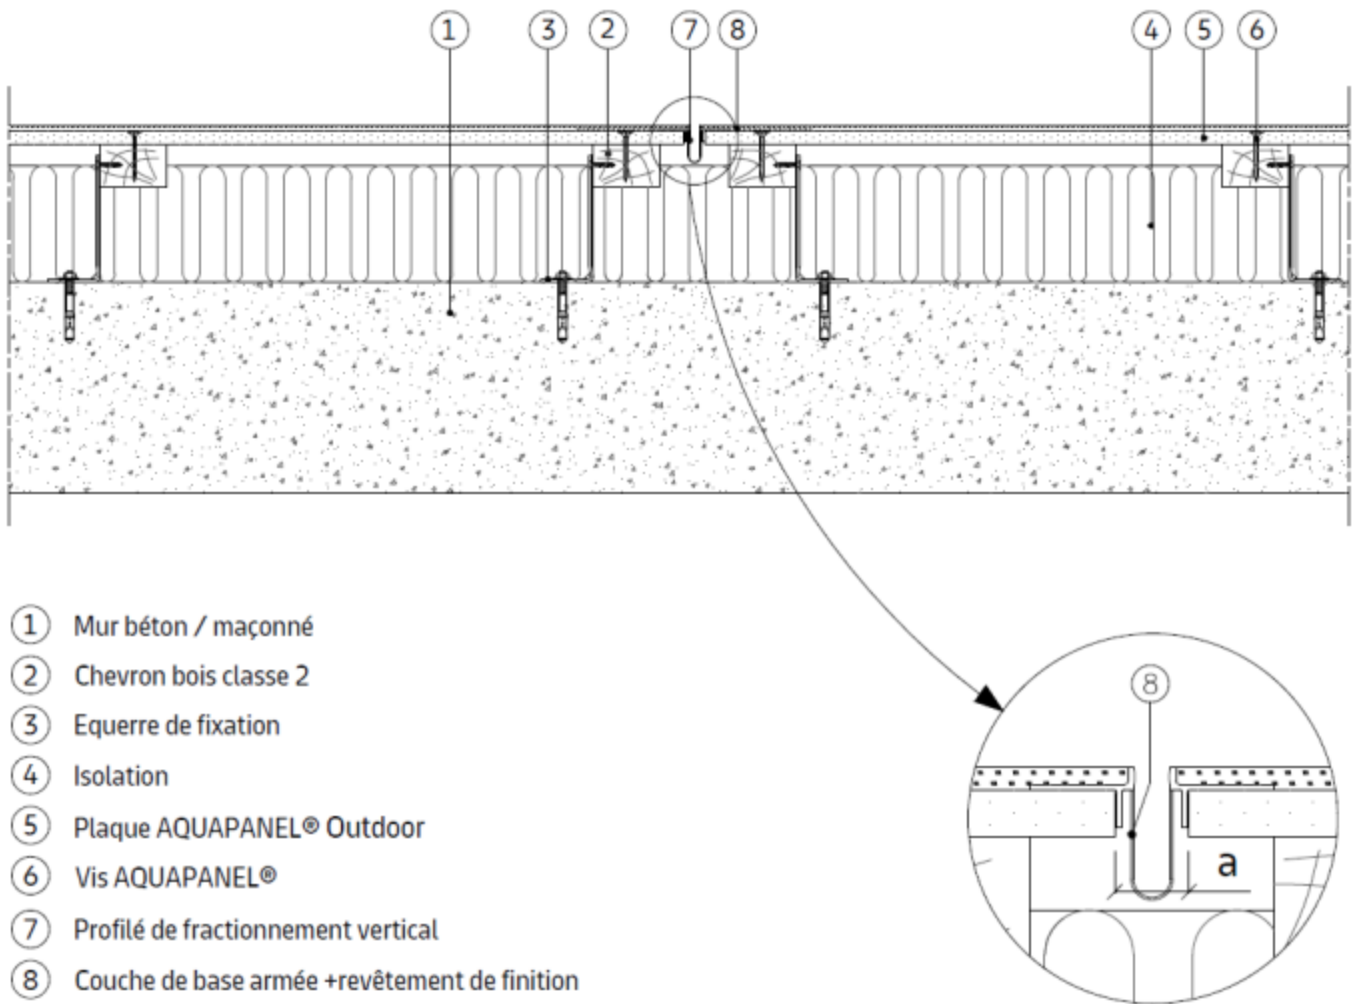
Joint de fractionnement vertical tous les 15 m – Coupe horizontale sur ossature bois
